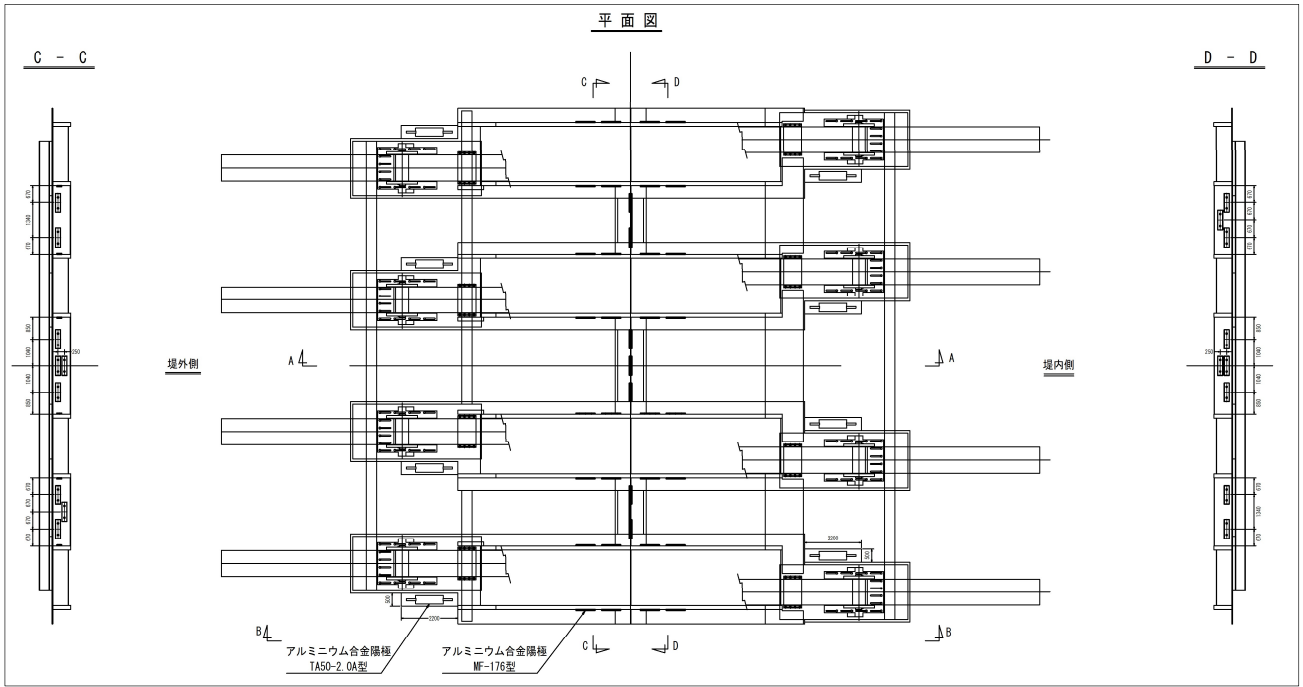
アルミニウム合金陽極配置図 (回転台, 基礎部他)
